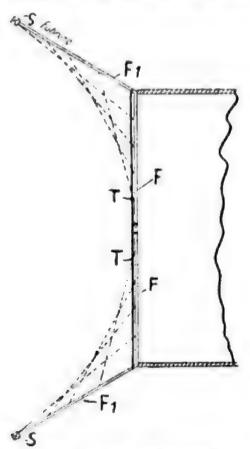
Tor für Luftschiffhallen, System Barkhausen. Ausgeführt an der Halle in Känigsberg.
